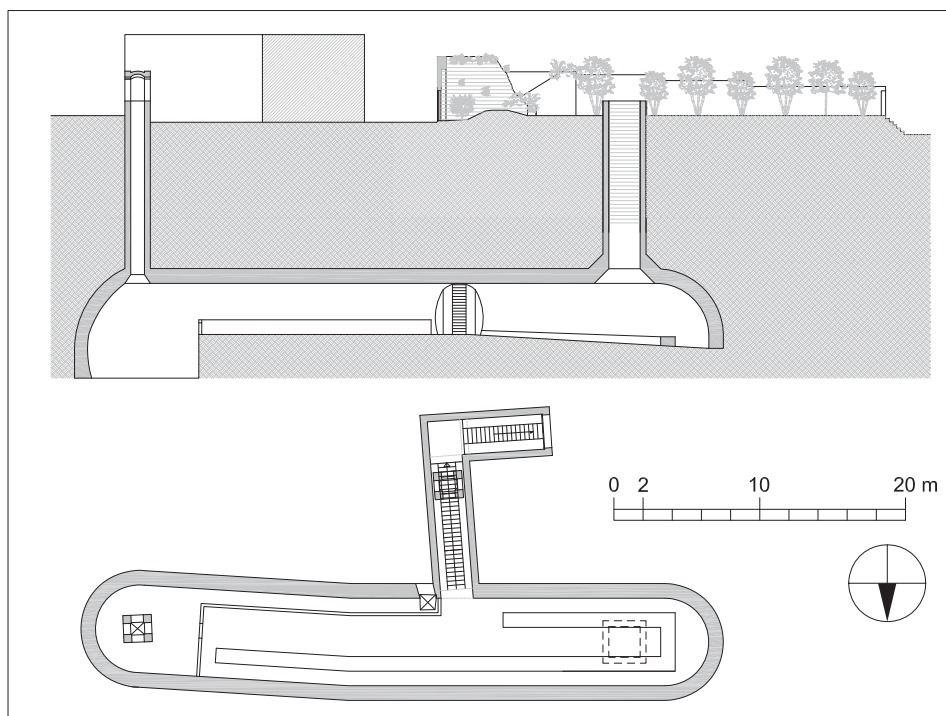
Comiziano, cantina C2. Pianta e sezione longitudinale.
